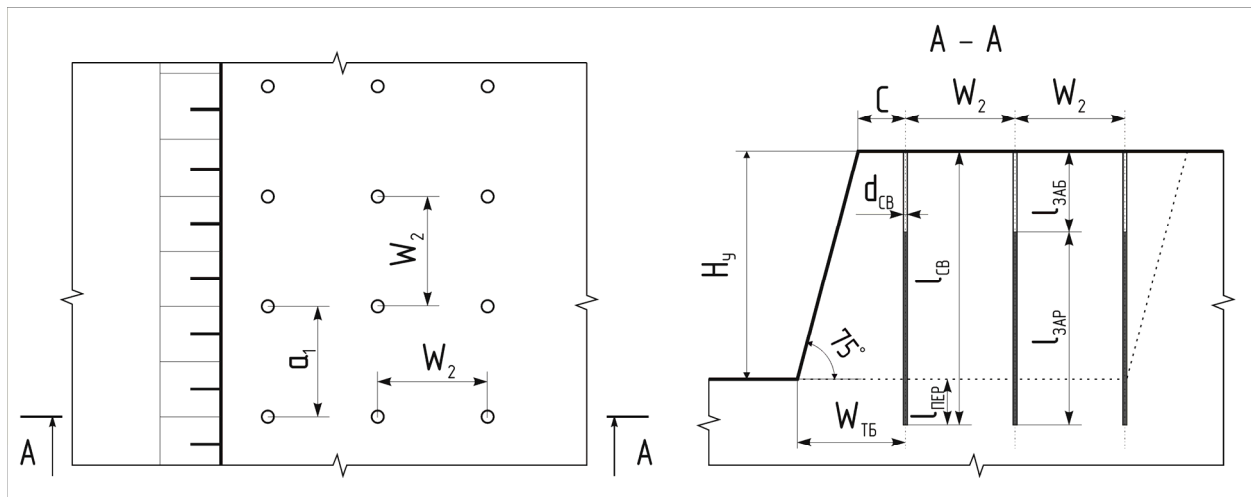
Схема розташування свердловин на розкривному уступі
